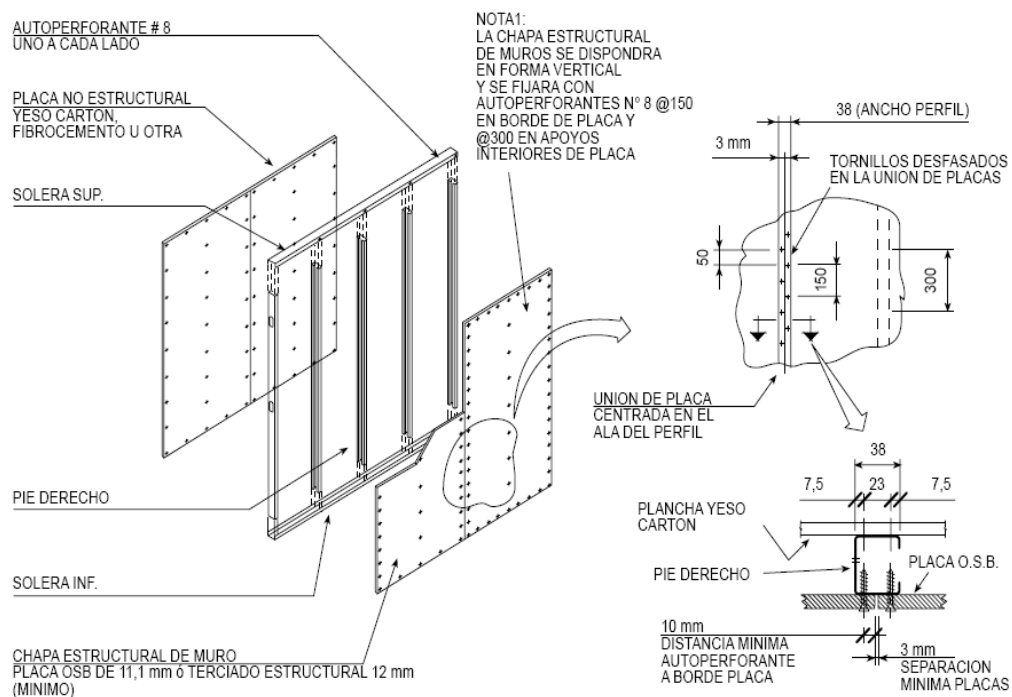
Muro o tabique típico estructurado en perfiles metálicos liviano
